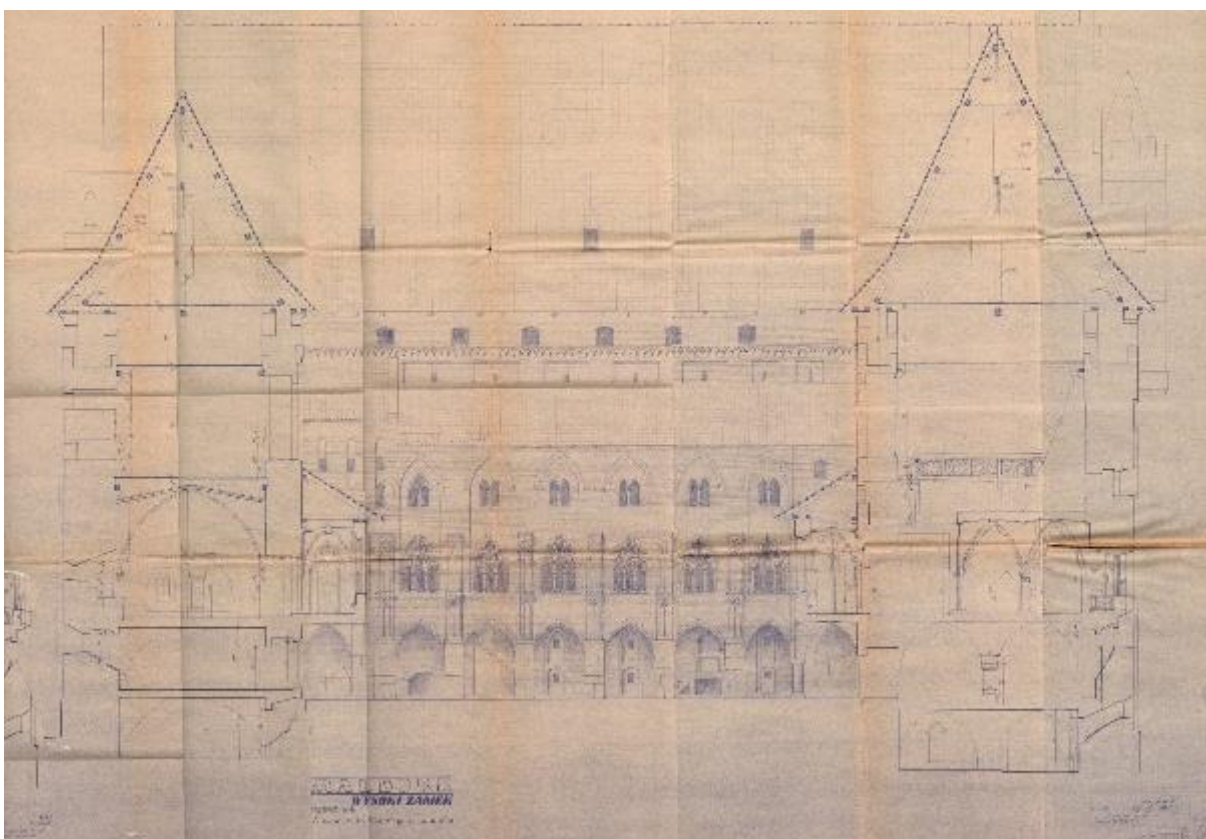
Prace przy rekonstrukcji krużganków i wnętrzu Zamku Wysokiego, Marienburg Baujahr 1986 r.
